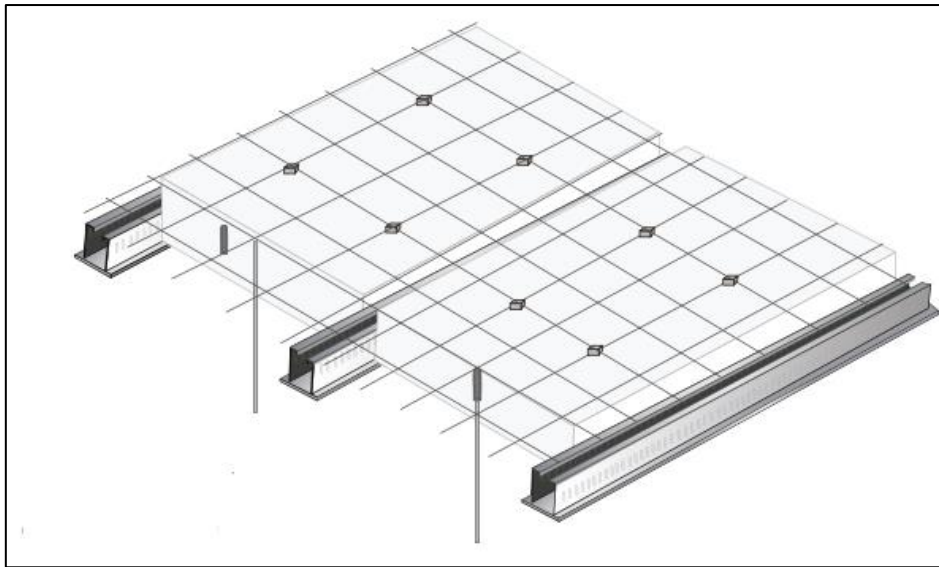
Malla electrosoldada en losa aligerada con VIGACERO. Recuperado de Manual de VIGACERO (2016).
